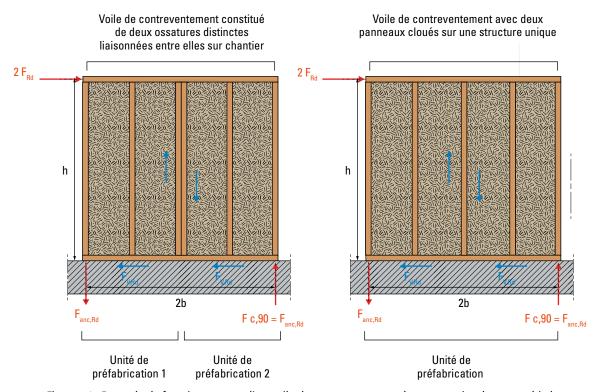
Exemple de fonctionnement d'un voile de contreventement à ossature simple ou combinée
